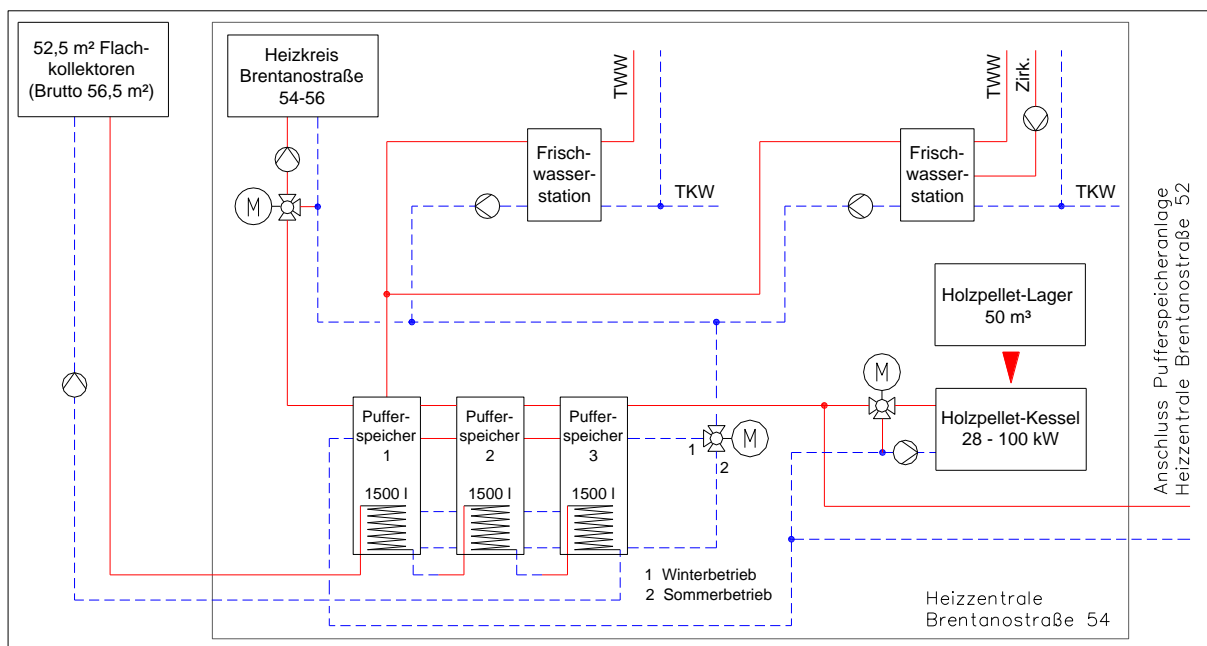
Vereinfachtes Hydraulikschema Anlage Brentanostraße in Kassel (Ausführung Schüco)
